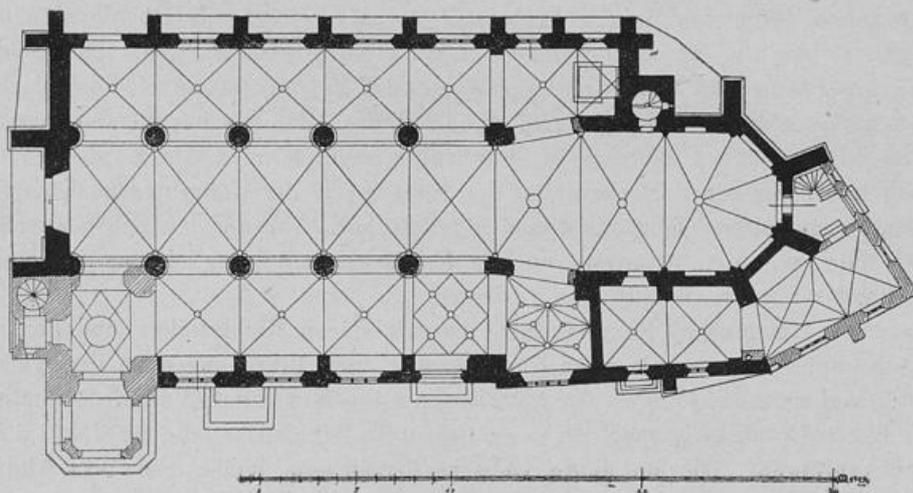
Kreuznach, St. Nikolauskirche. Grundriss nach der Wiederherstellung.
